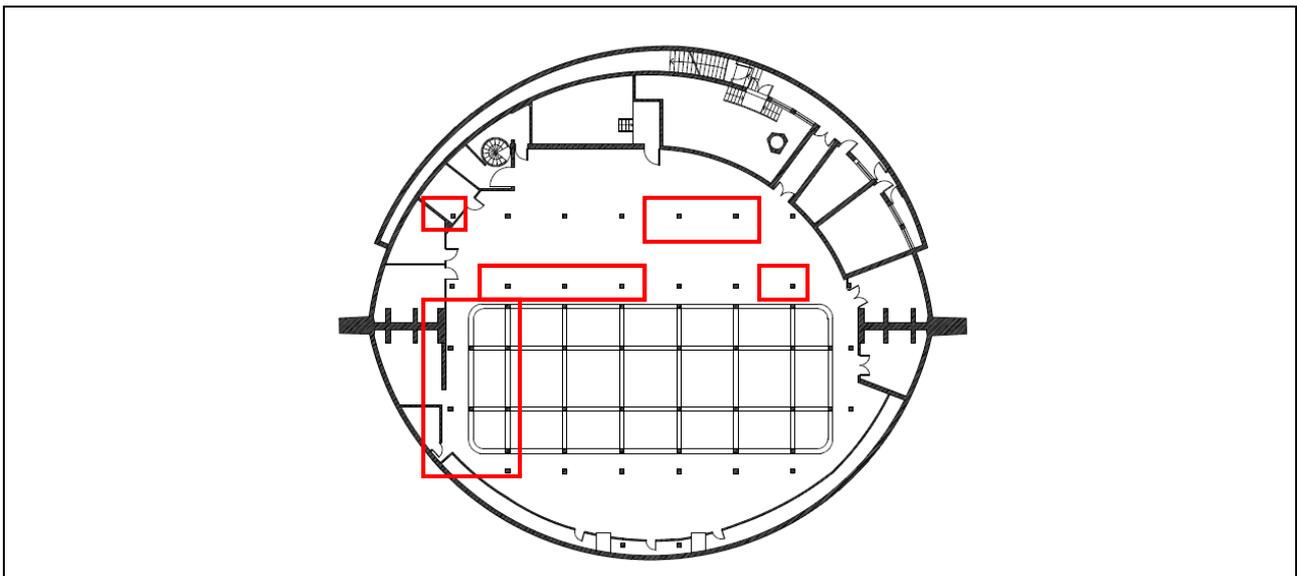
Pilastrini danneggiati dalla corrosione
